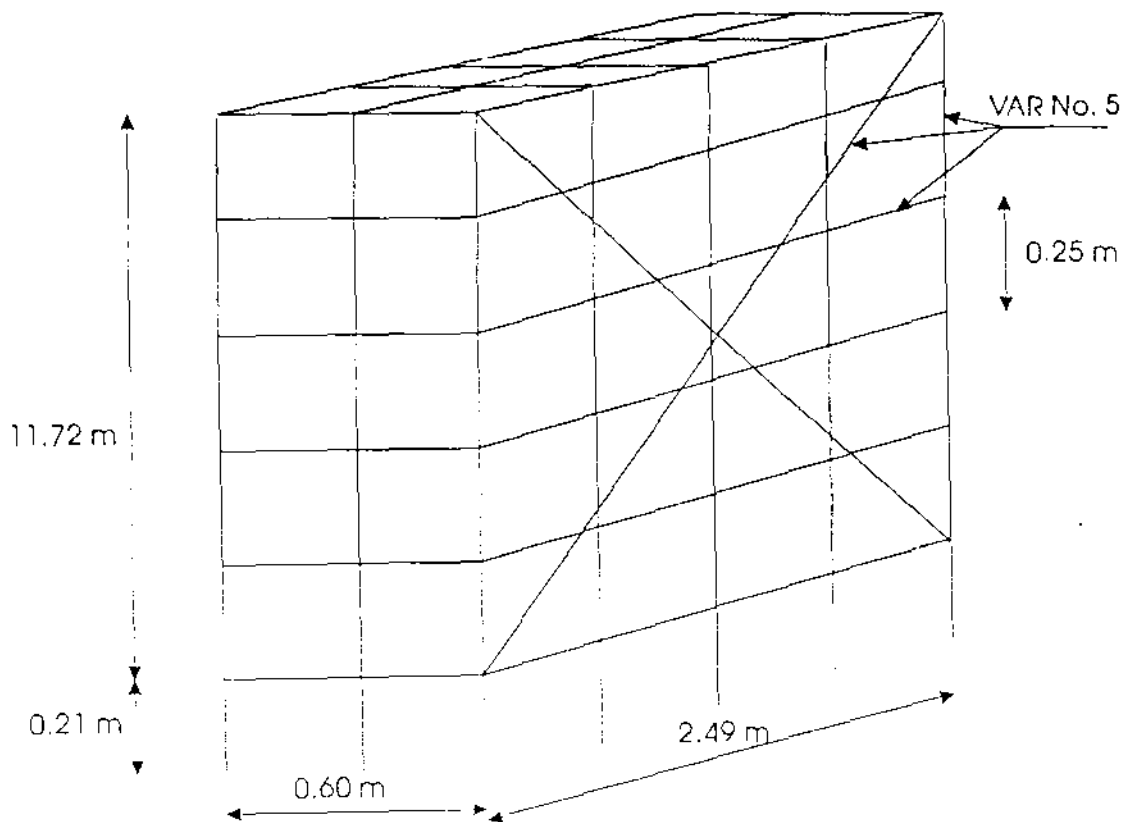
ARMADO DE TABLERO DEL MURO COLADO "IN SITU"
